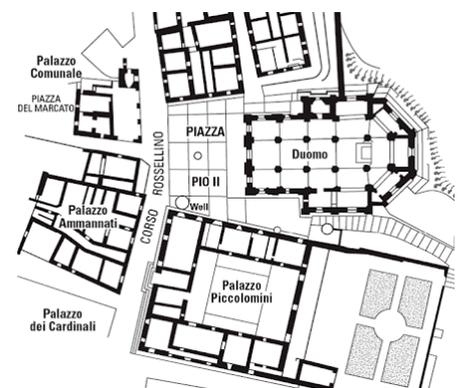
Planta Piazza Pio II. Pienza, Italia.
